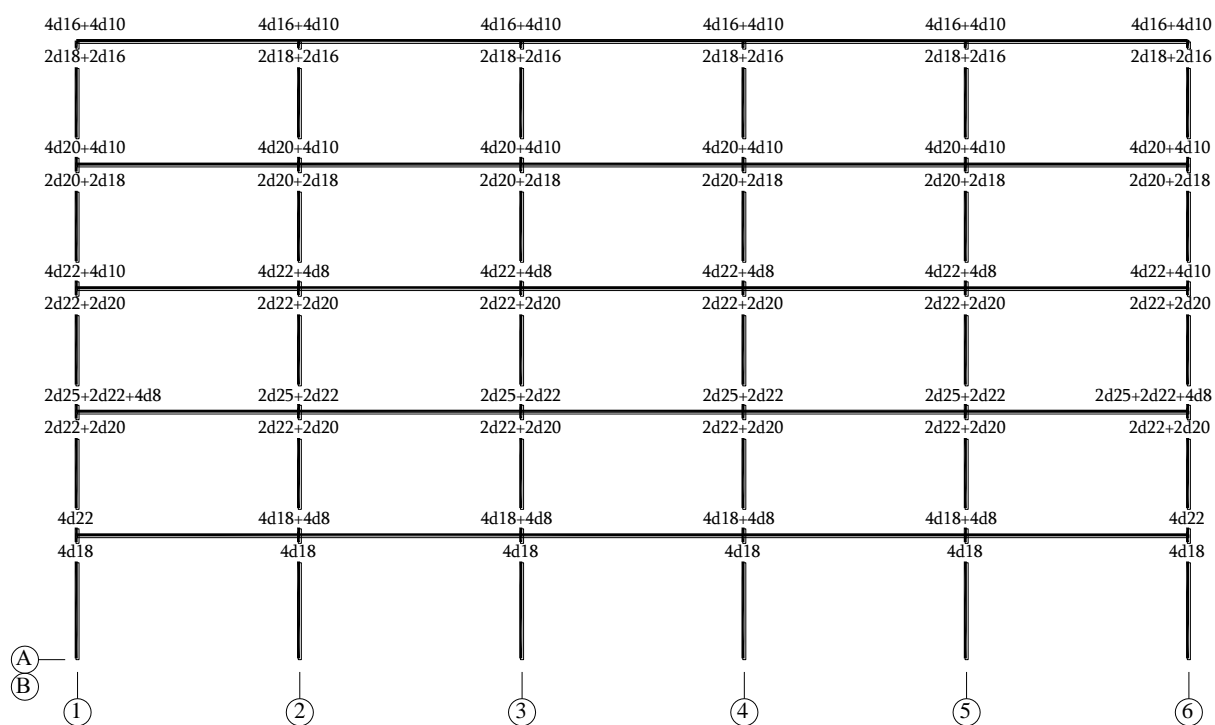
Продольное армирование балок рам, расположенных по осям А и В, в соответствии с результатами конструирования:
